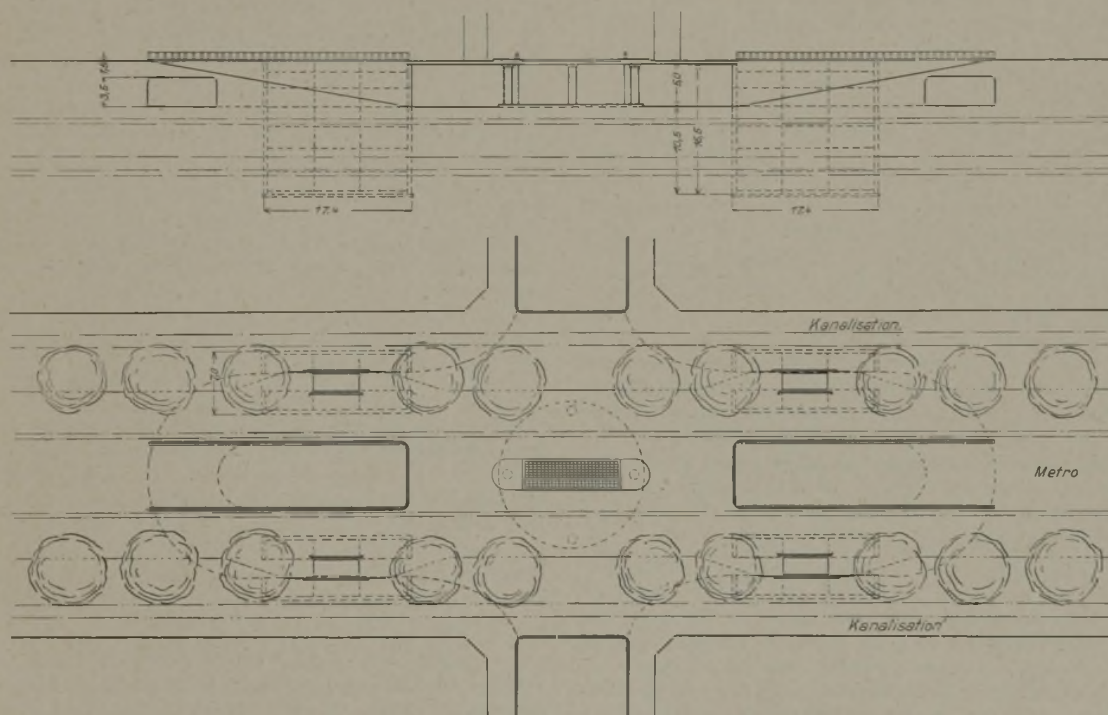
Aufriß und Grundriß einer „Auto-Case“-Anlage in Verbindung mit Unterführung. (1:800).
